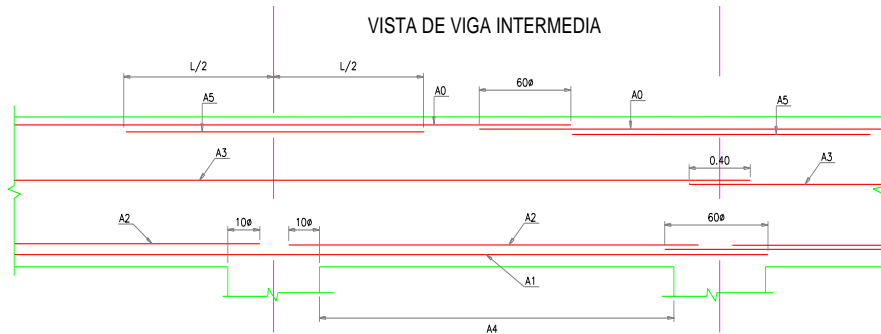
Posición de Armaduras de Planilla para el Dimensionado de Vigas
